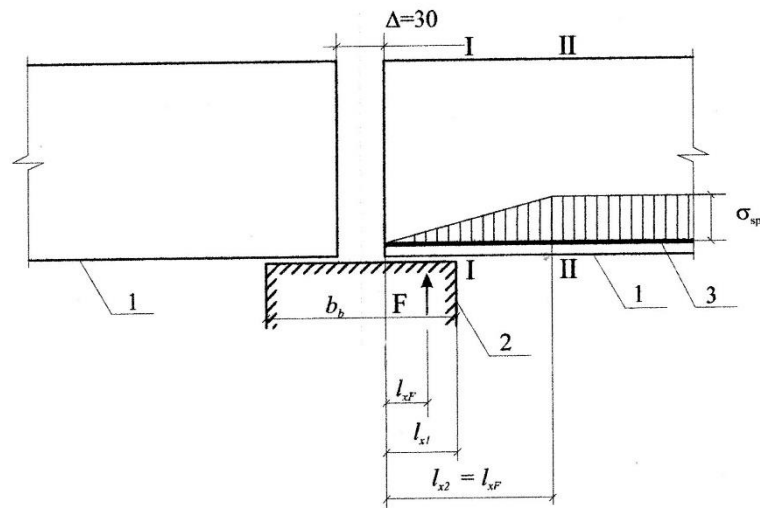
Схема эпюры опирания плиты 1 – плита; 2 – ригель; 3 –арматура.
